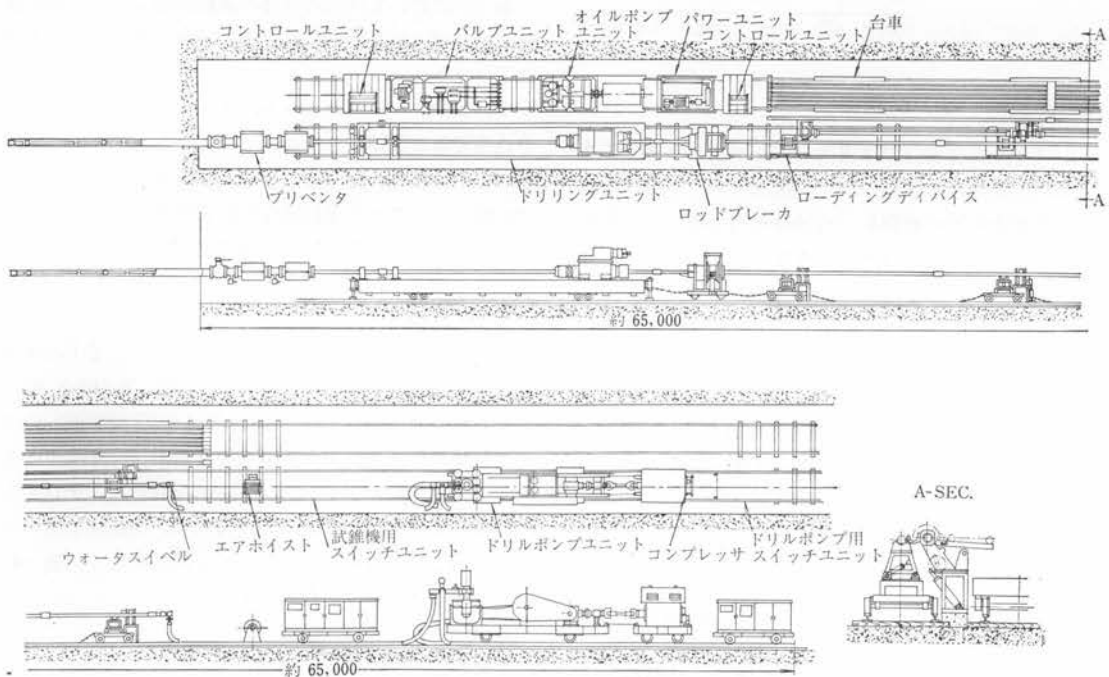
大形回転試験機 (水平 2,000 m 級) 全体配置図
